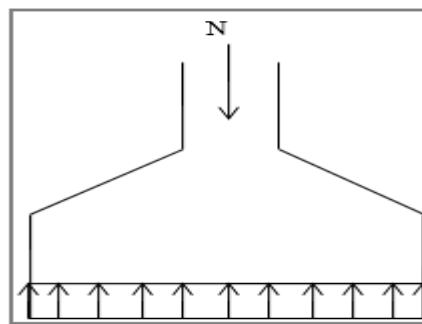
schéma d'une Semelle isolée sous poteau.
